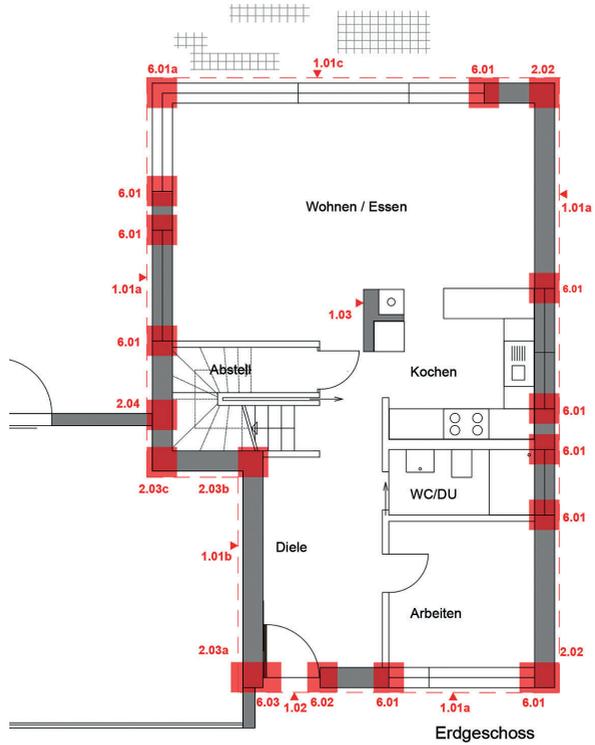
Beispiel: Kennzeichnung von Wärmebrücken im Grundriss, Quelle: C. Uske
